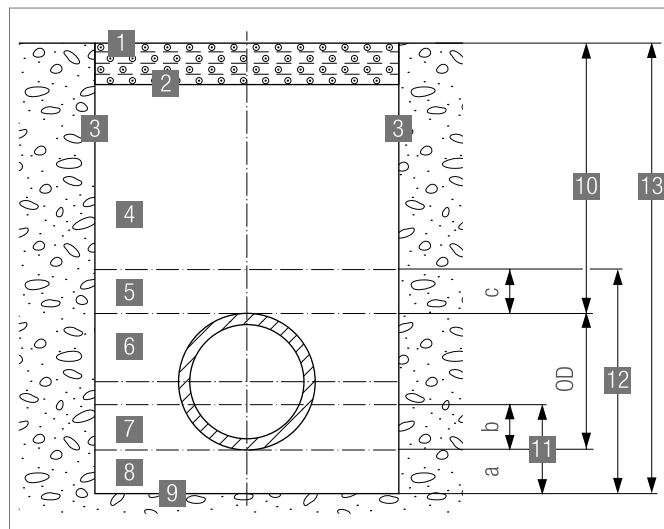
Схематическая конструкция траншеи для укладки труб
